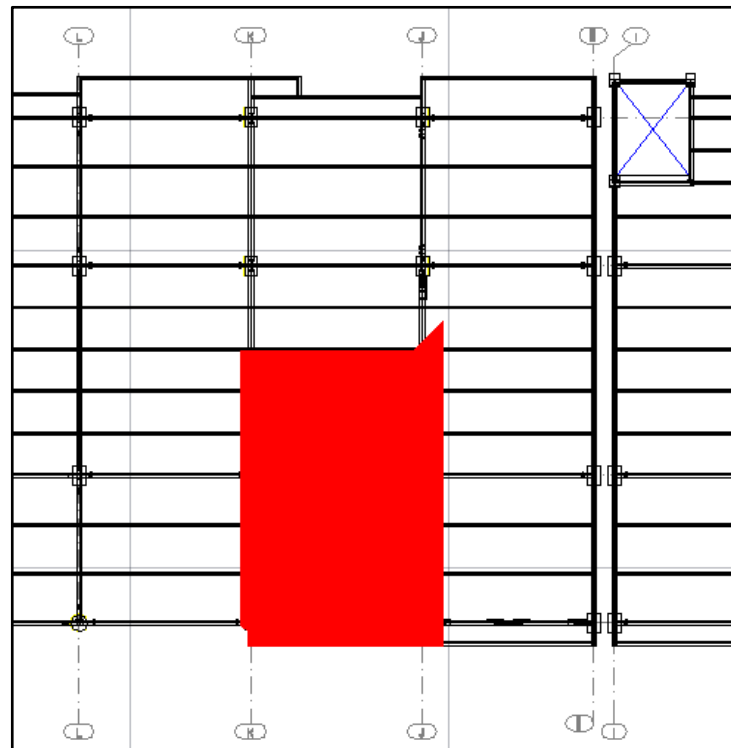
Localización de losas nivel 1. Fuente: plano de planta y alzada 14.0.
